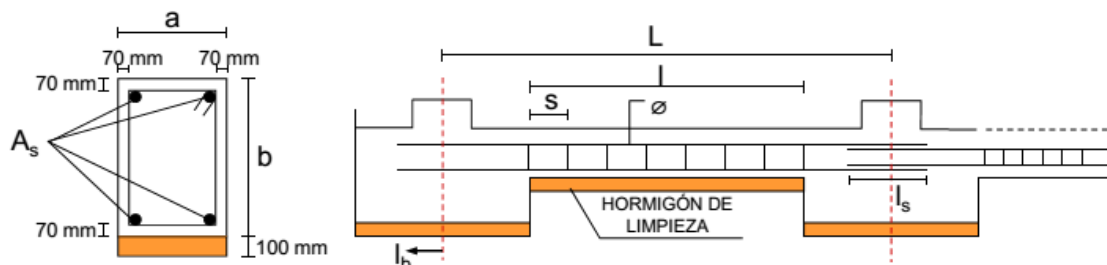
Viga de atado (Estructuras de cimentación y contención)
